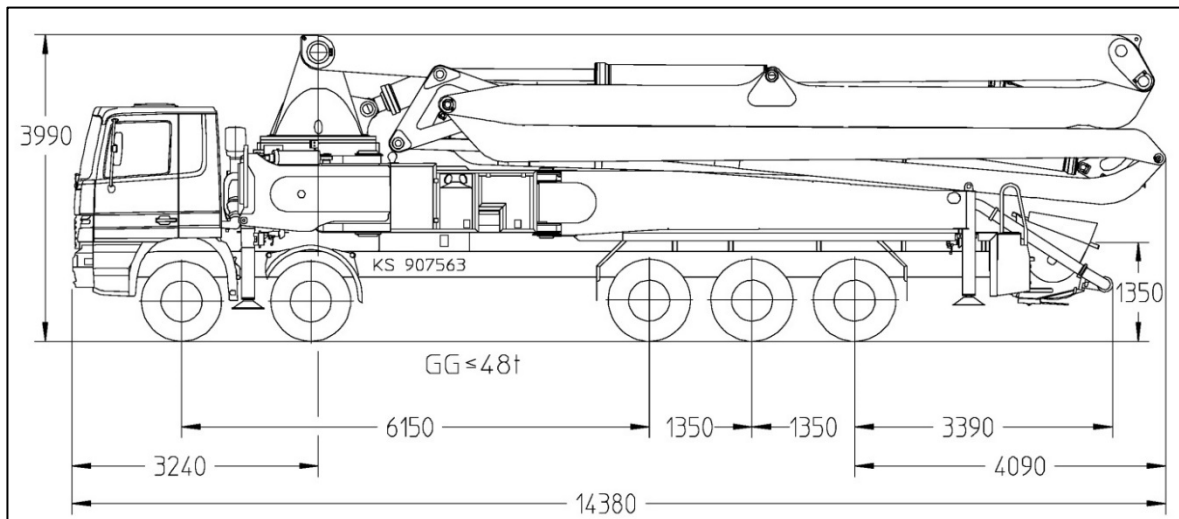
Aufbau einer Autobetonpumpe²⁰⁵
